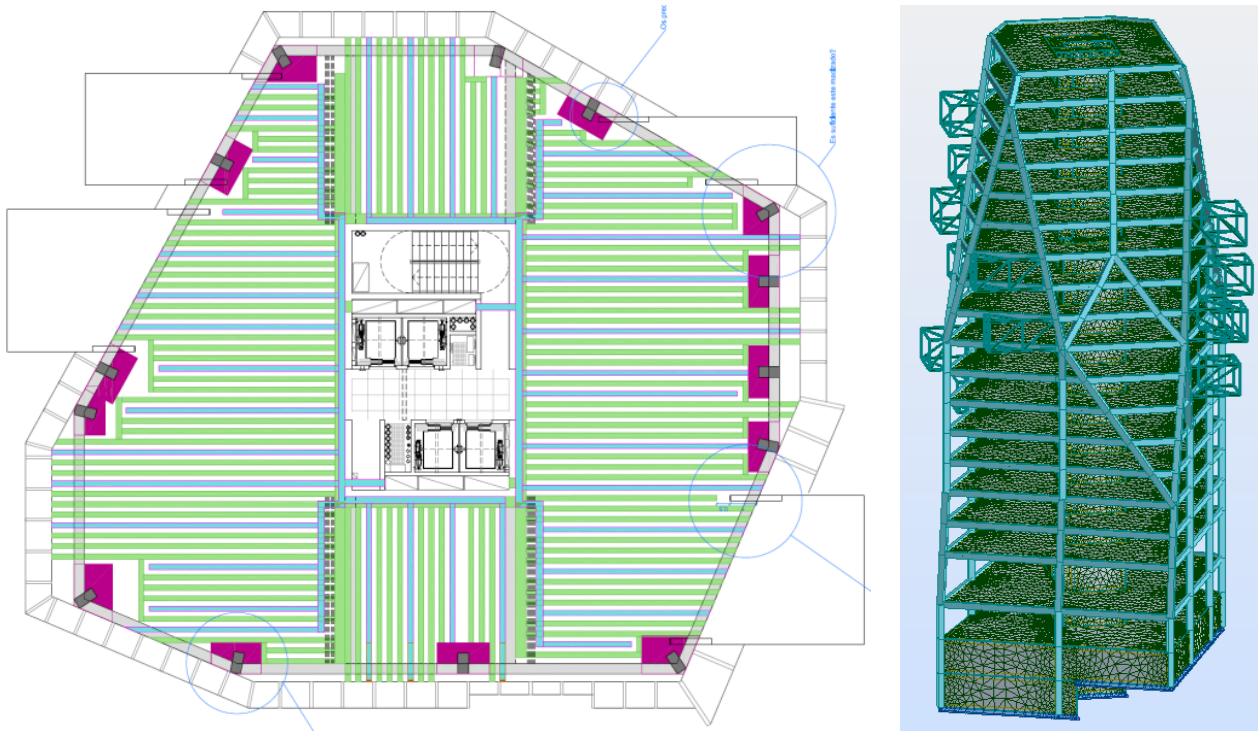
Planta tipo y modelo en MEF de la estructura de la Torre Nobelia
